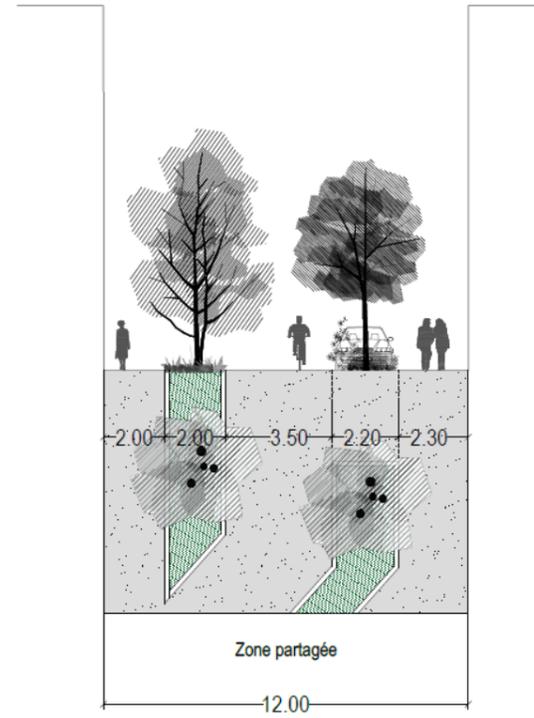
Rue Pierre Sémard - Section zone partagée – Coupe 16
